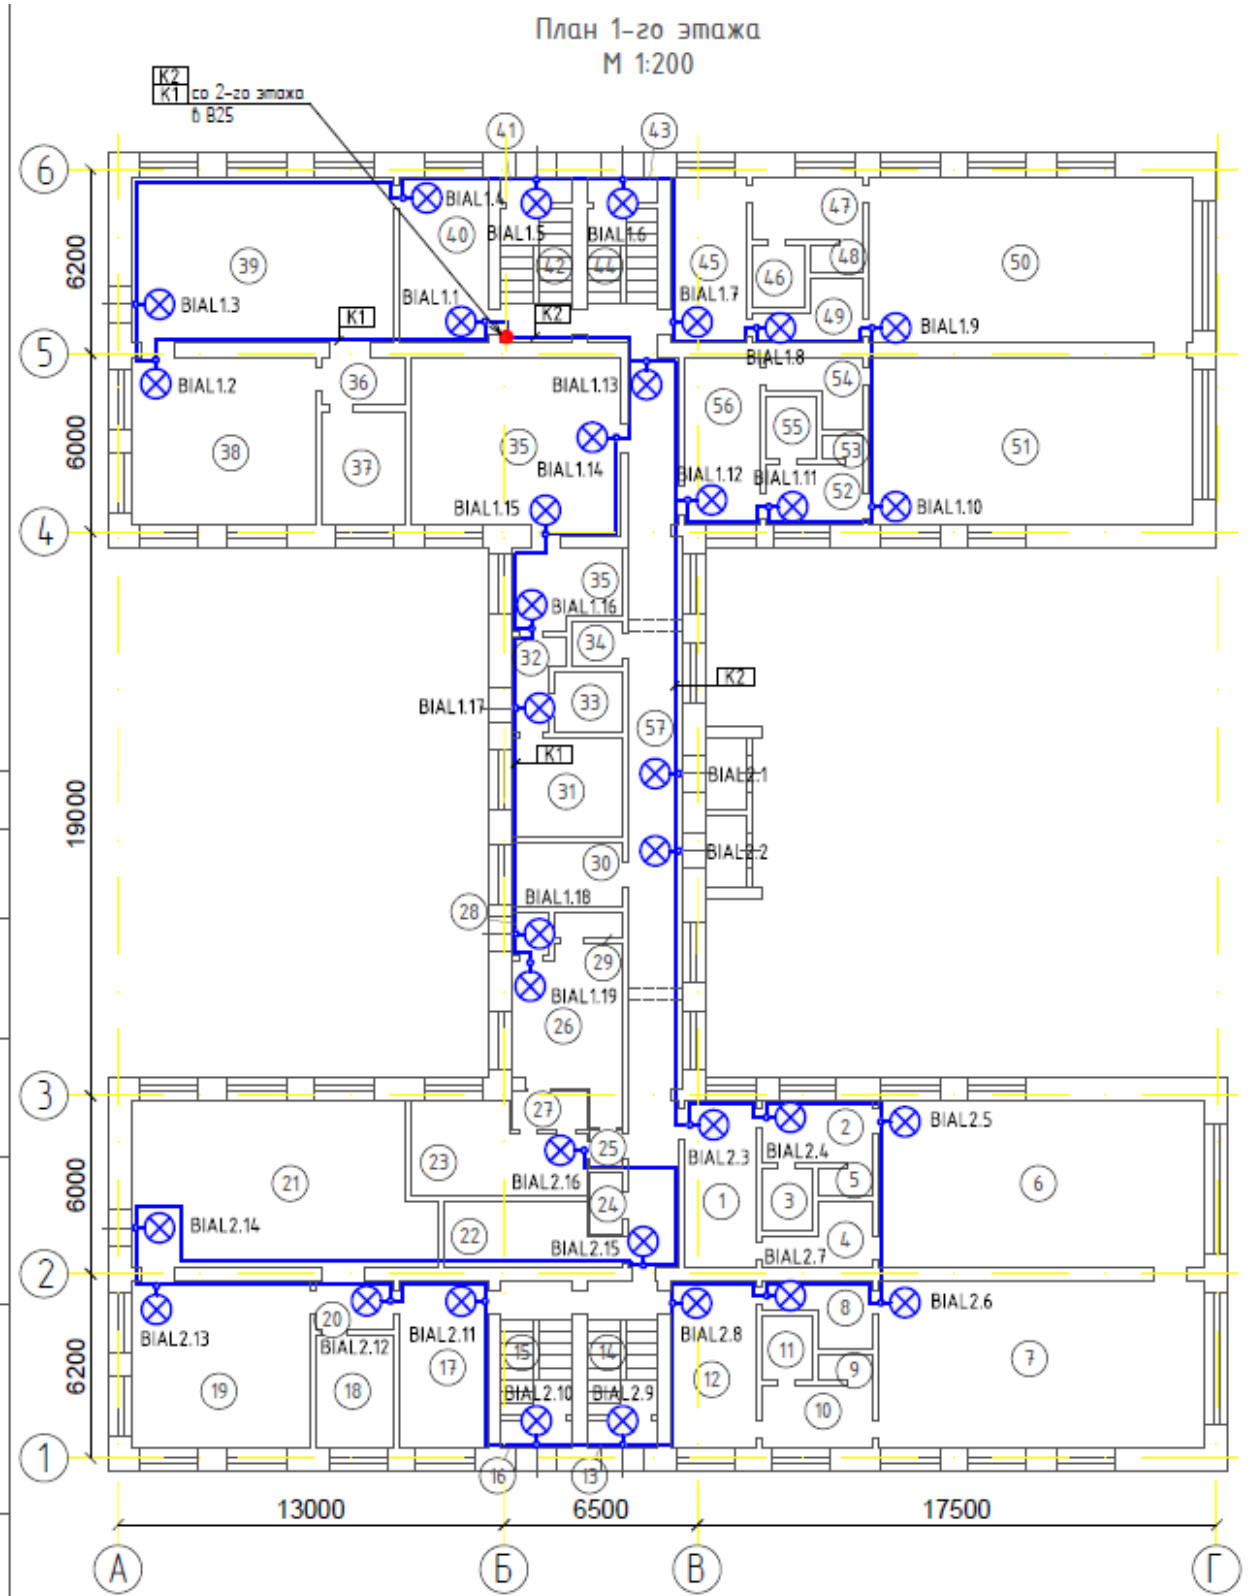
План 1-го этажа сети светового оповещения о пожаре
